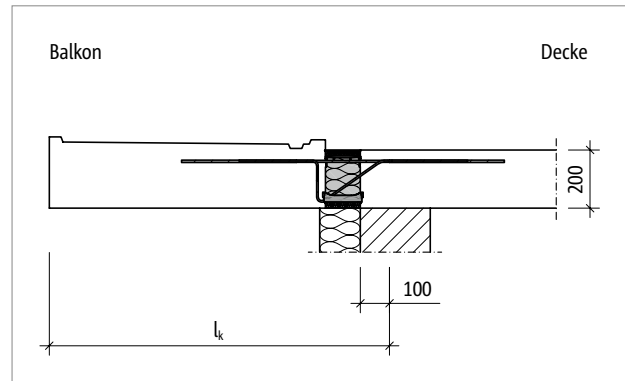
Schöck Isokorb® XT Typ KL: Statisches System
